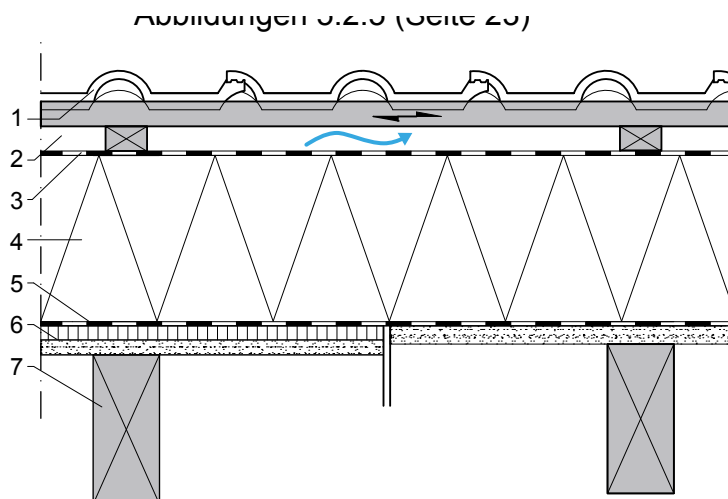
Dachaufbau mit Aufdachdämmung GK 0
